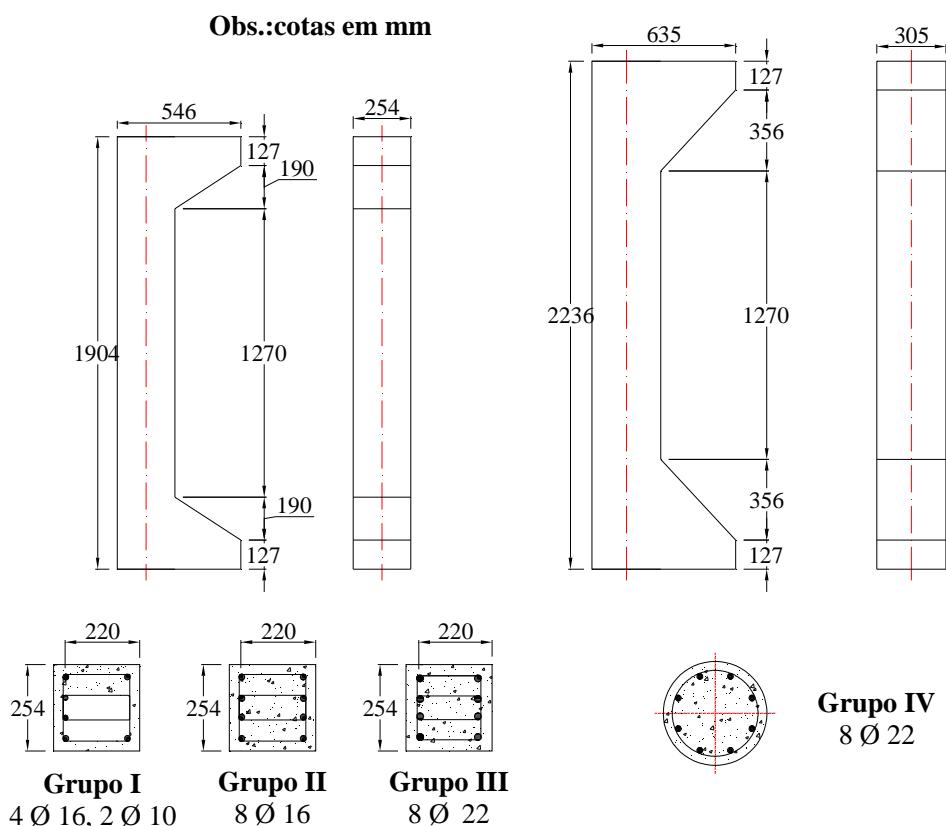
Características geométricas dos pilares ensaiados (HOGNESTAD, 1951)
